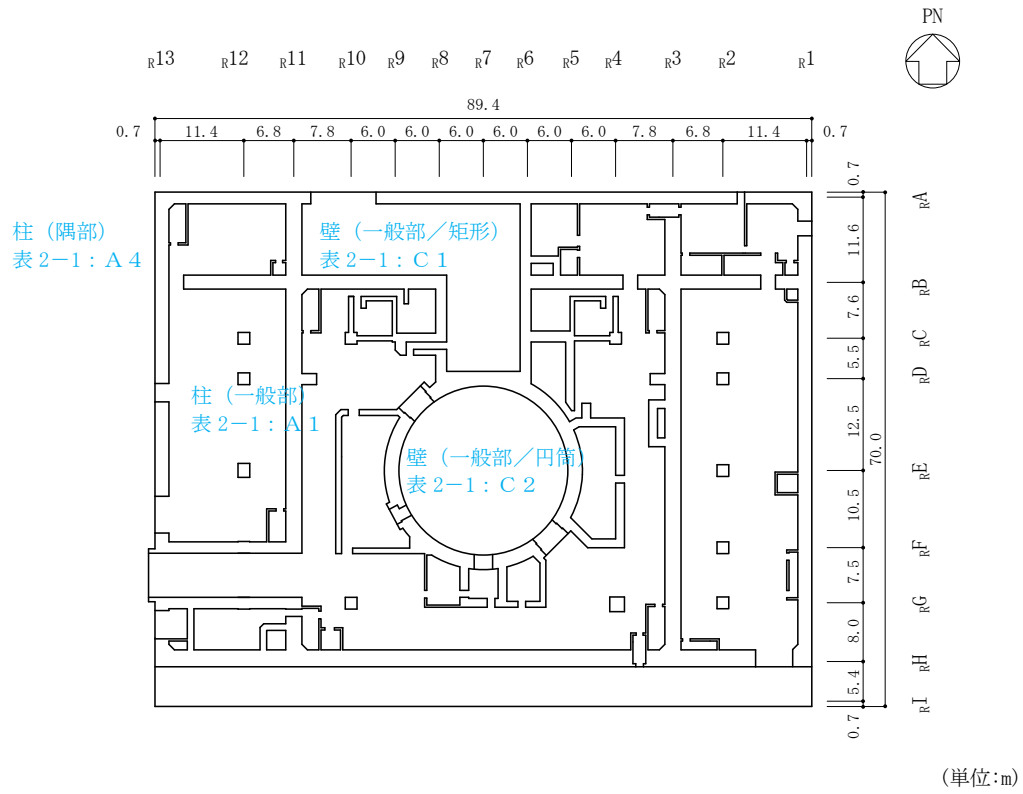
(3) 原子炉建物の概略平面図 (EL 15.3m)
